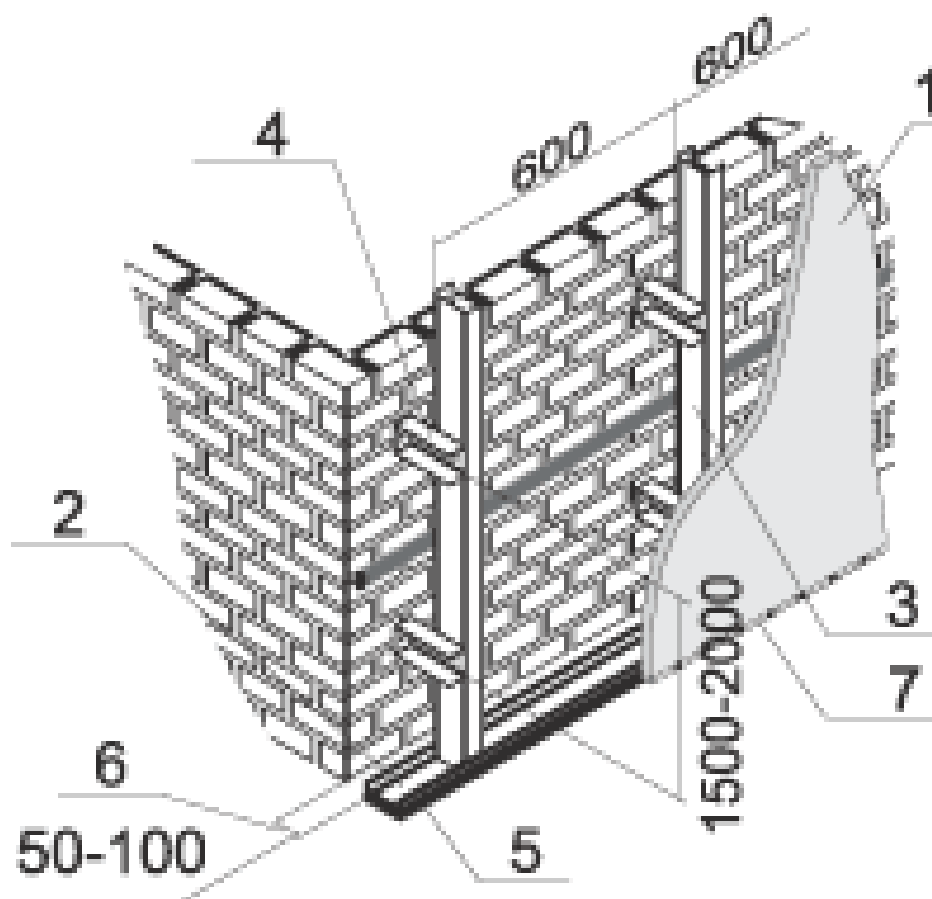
Облицовка кирпичных, бетонных или иных стен гипсокартонными листами (ГКЛ) по металлическим профилям
